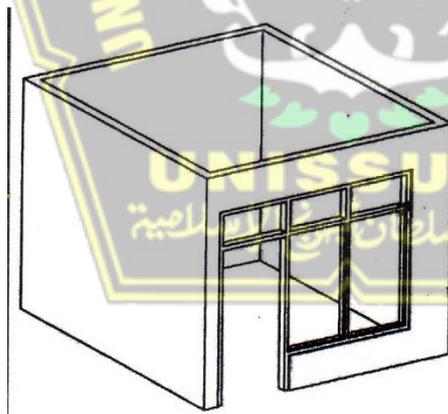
Pemakaian Overstek yang Terlalu Panjang
